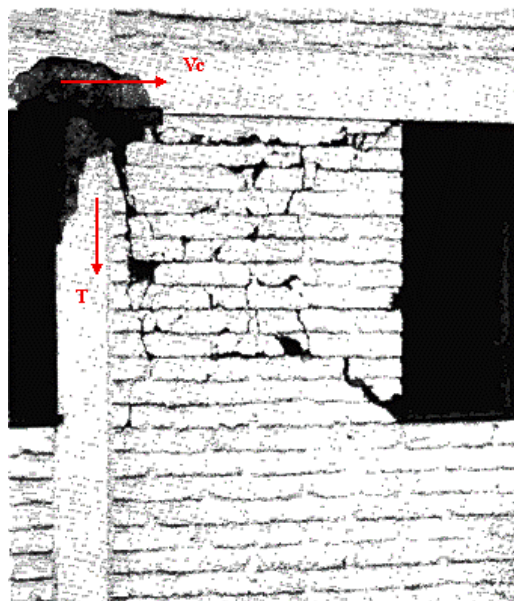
Falla de corte en columna de muro de mampostería. (Terremoto de Chile, 2010)
